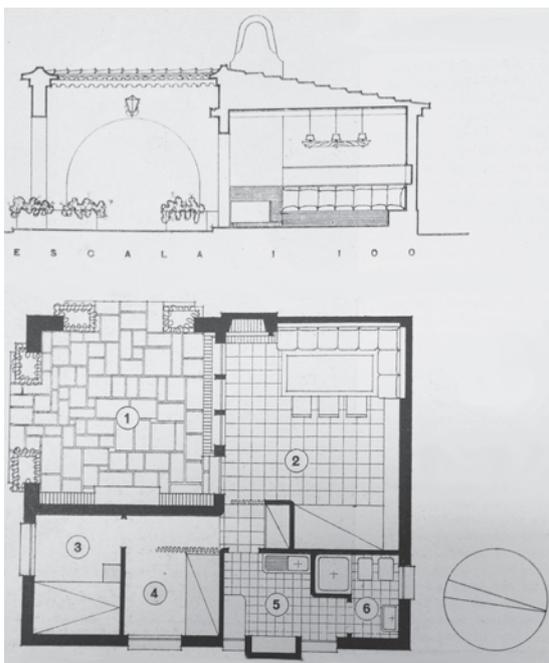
Planta Casa de Férias João Guilherme Faria da Costa
